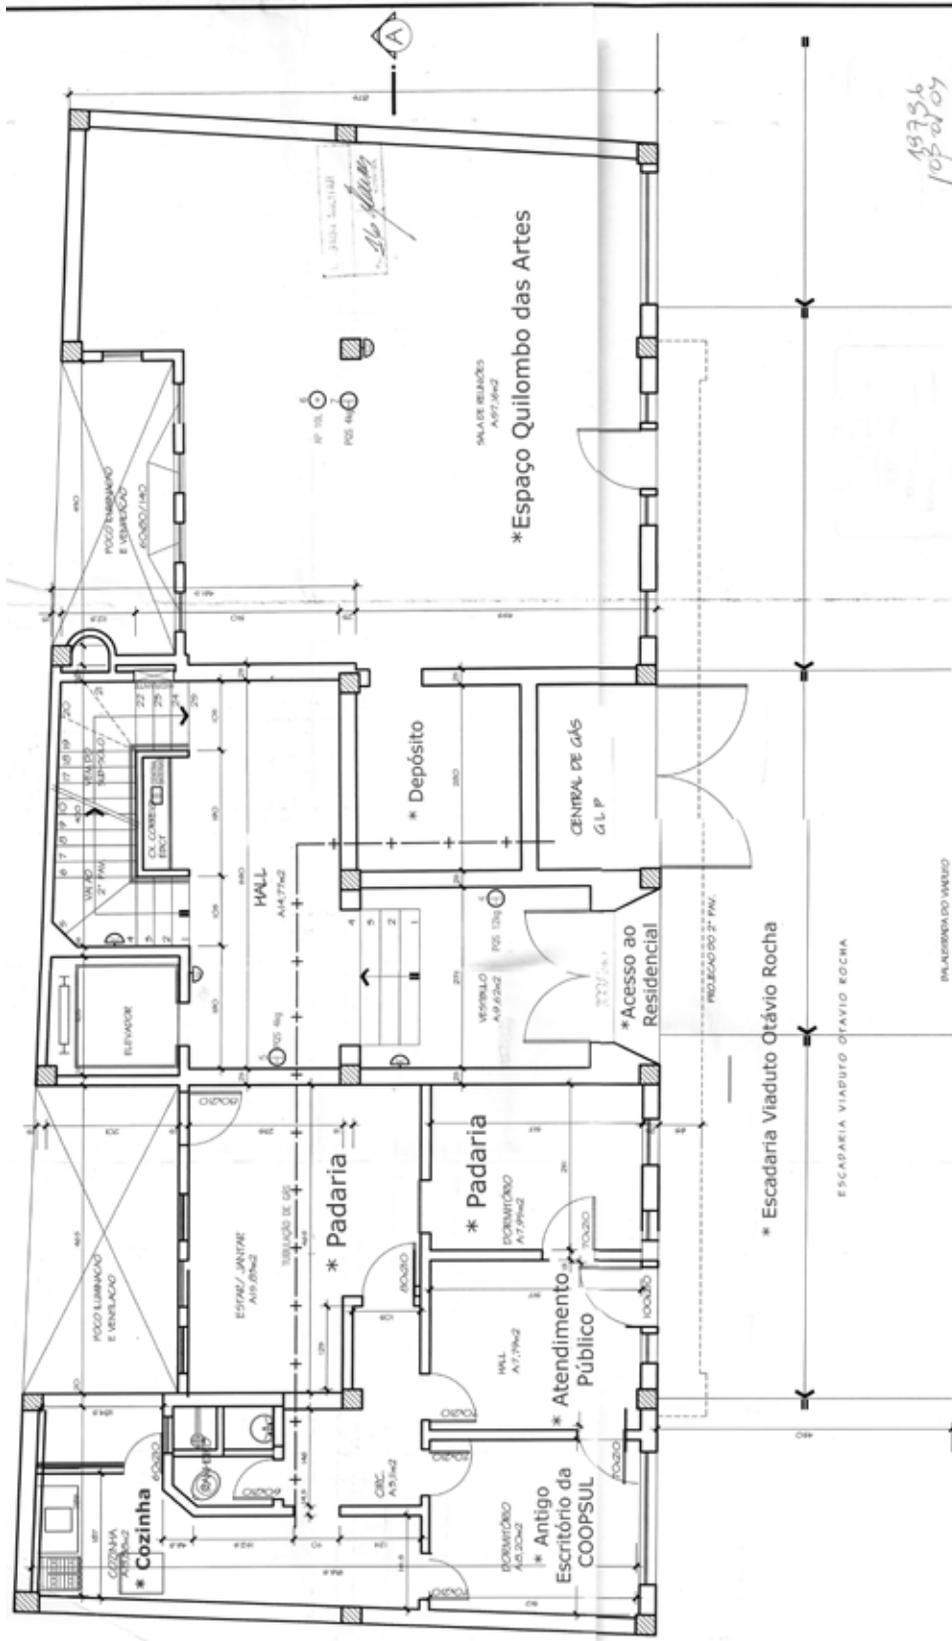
Planta do pavimento térreo. Digitalização do Alvará dos Bombeiros.
